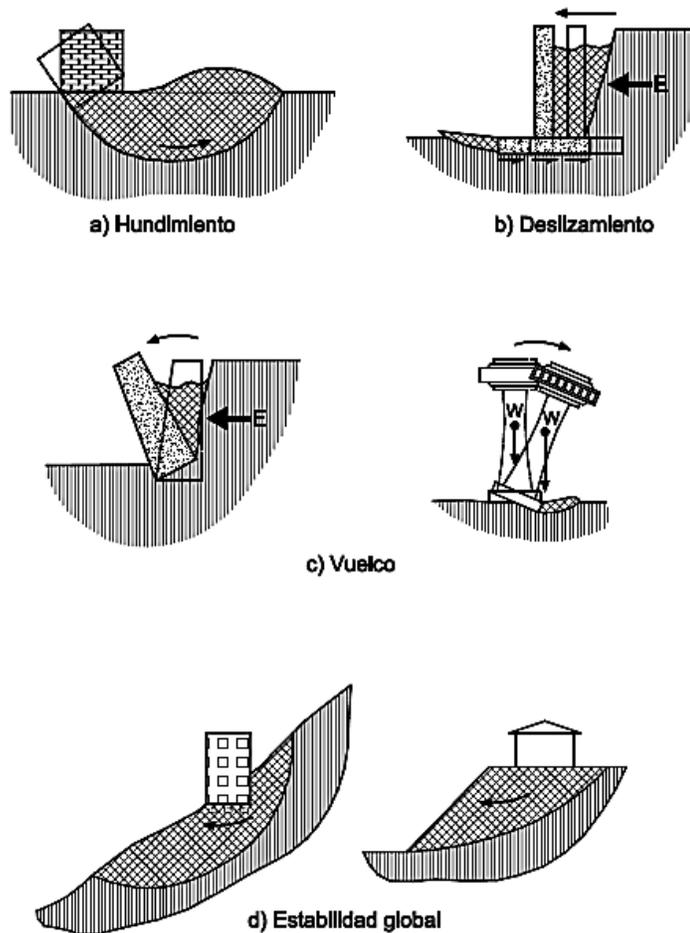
Ejemplos de Estados Límite de Falla.³
